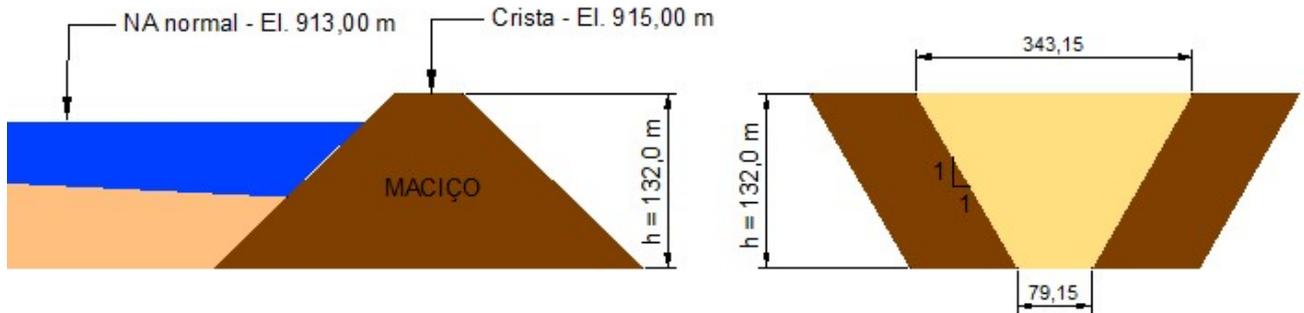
Croqui da brecha – Barragem 2 – Cenário final
